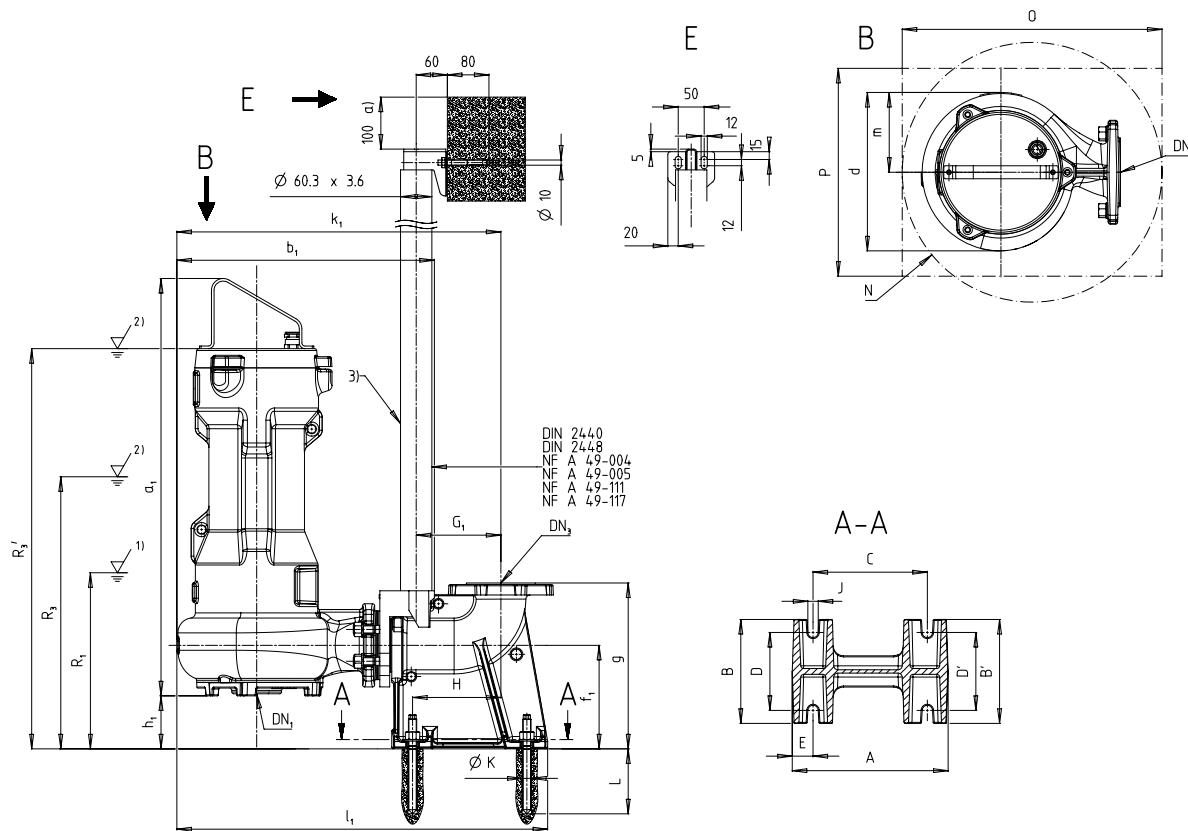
Amarex 80, instalação fixa, guiamento de 1 barra
